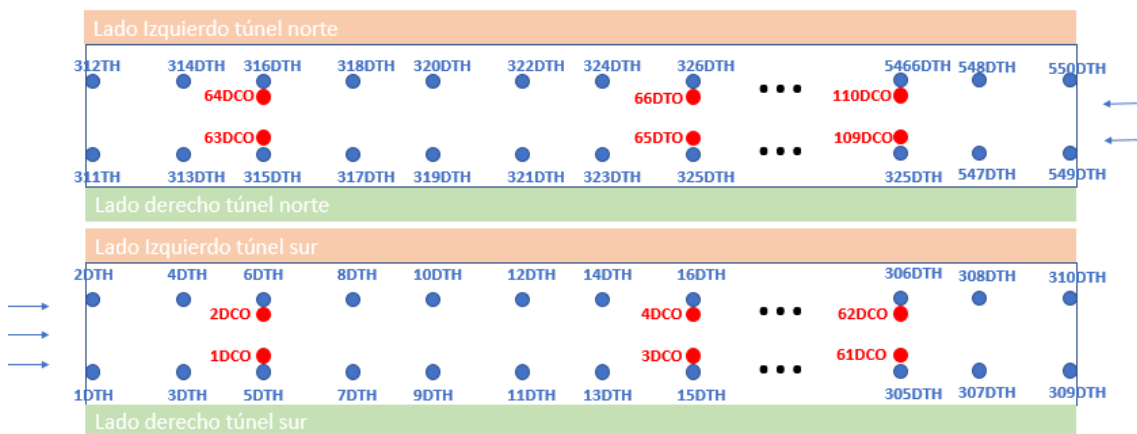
Ubicación y nombre de detectores CO y TH - Vista Planta
